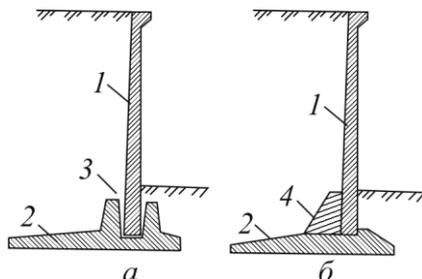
Сопряжение сборных лицевых и фундаментных плит: *a* – с помощью щелевого паса; *б* – с помощью петлевого стыка; 1 – лицевая плита; 2 – фундаментная плита; 3 – цементно-песчаный раствор; 4 – бетон замоноличивания
